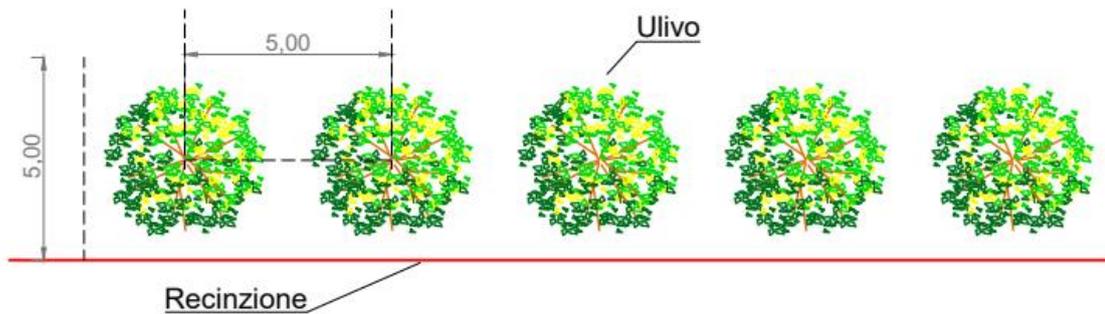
Fascia di mitigazione e schema del sesto dell'impianto
